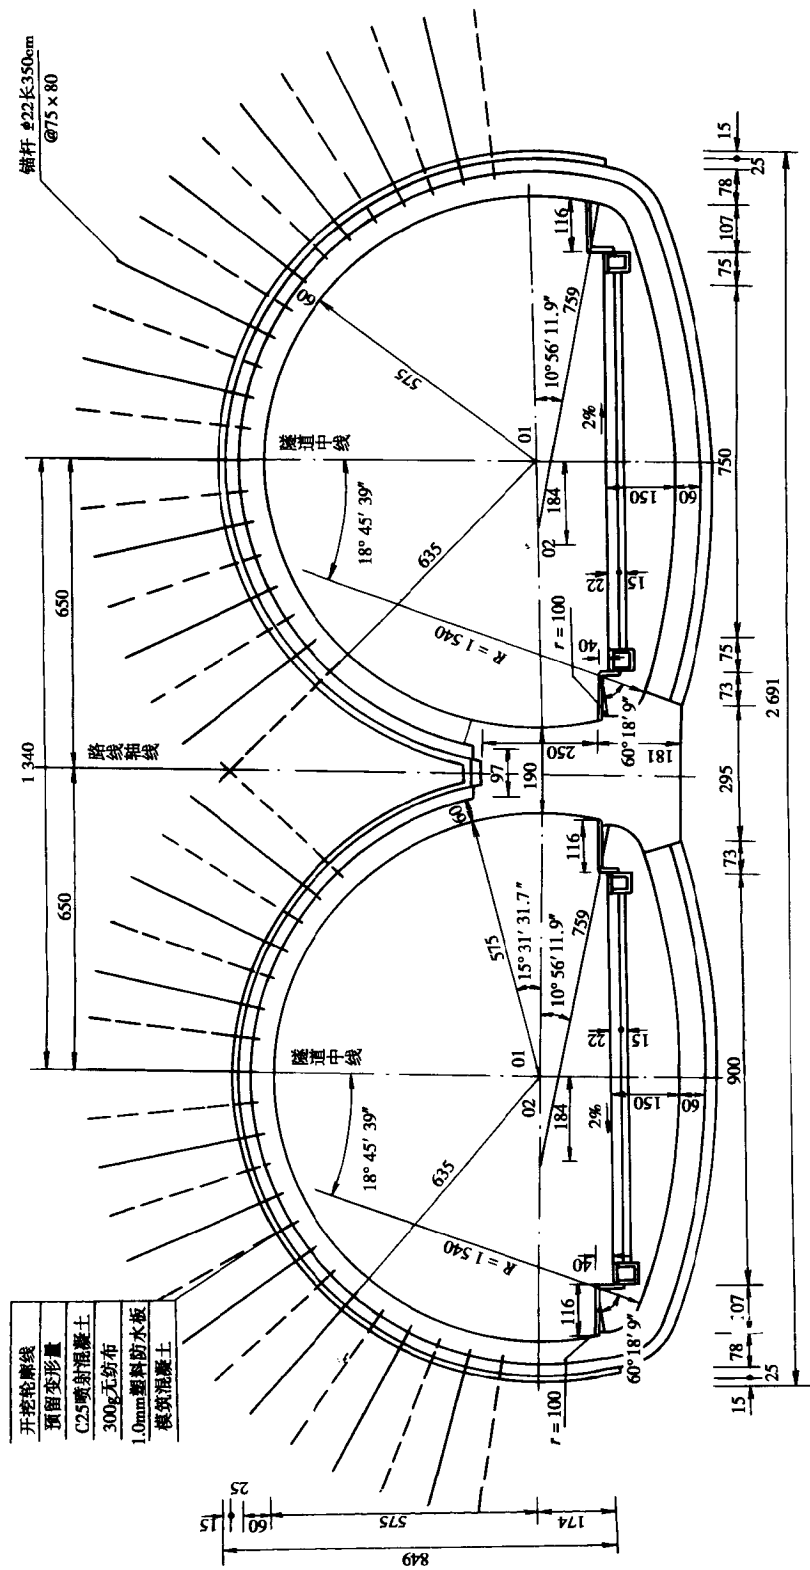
II 类衬砌断面图(尺寸单位:cm)
